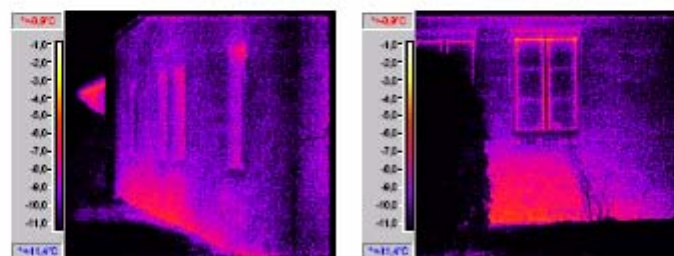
Detailansicht, Wärmeleitung aus einem Technikraum
